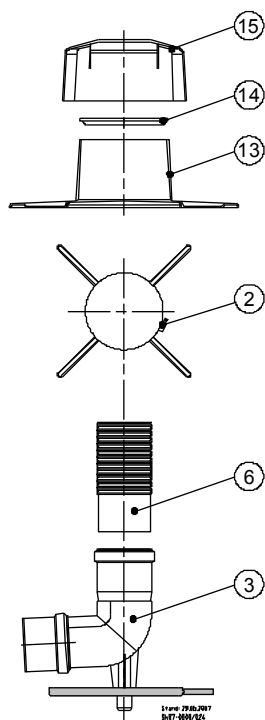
Detail-Zeichnung Befestigung Schachtabdeckung
